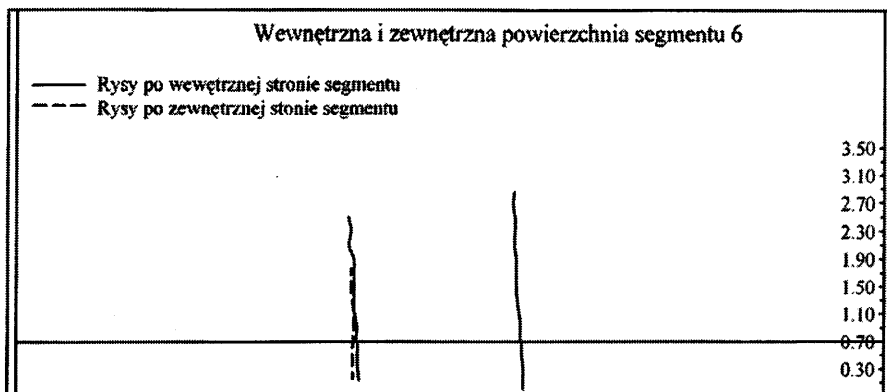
Układ rys na wewnętrznej i zewnętrznej powierzchni segmentu 6
